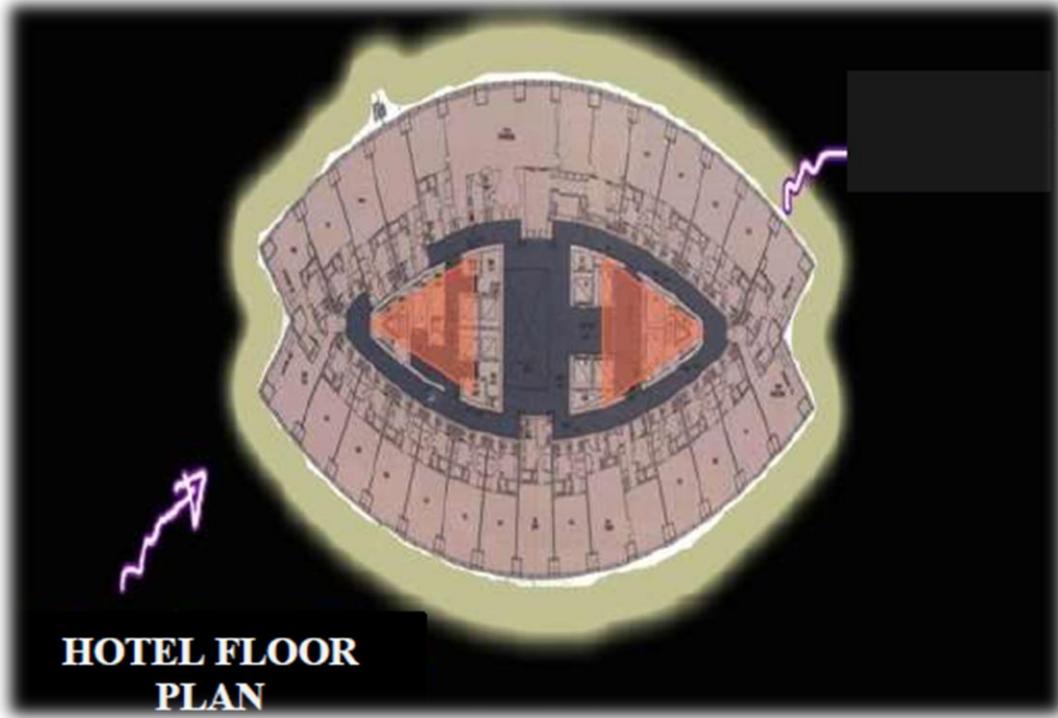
توضح المسقط الأفقي للطابق الأرضي
